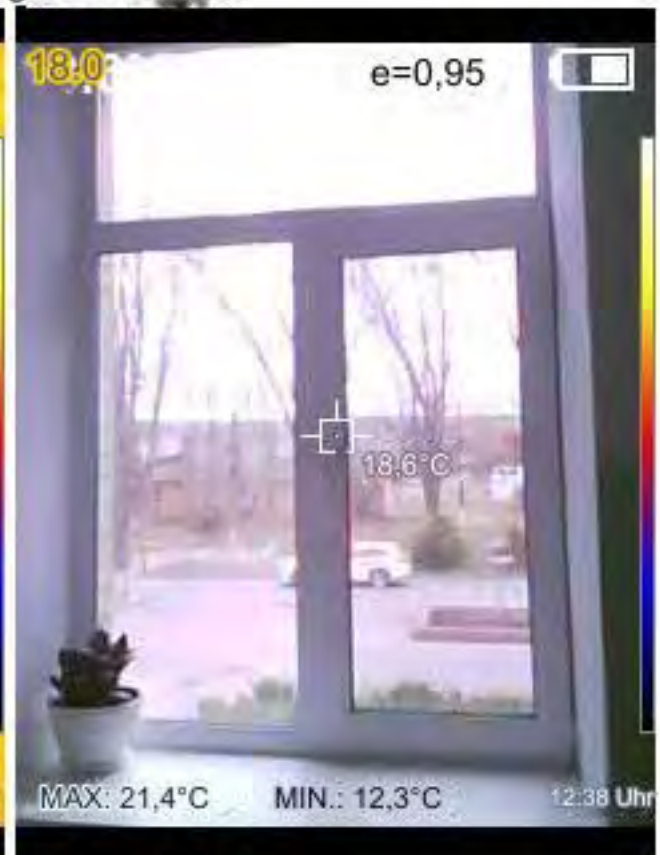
Fenster mit Doppelverglasung Typ 4-16-4.
